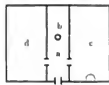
Grundriss des einfachen litauischen Wohnhauses.
